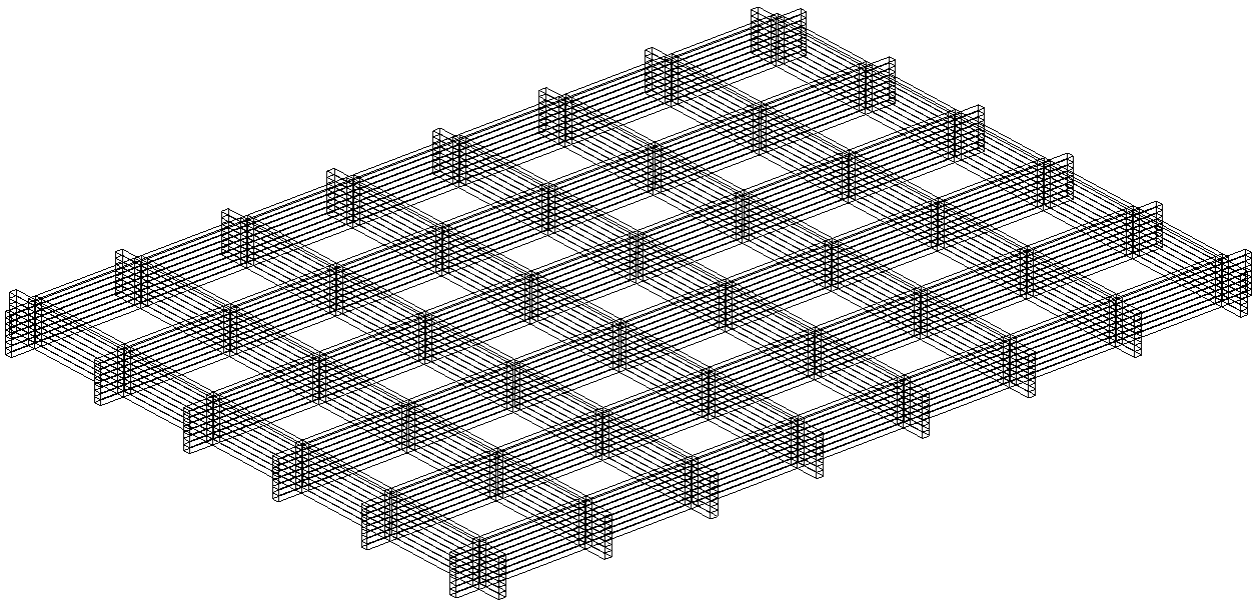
Расчетная схема плиты перекрытия, заданная объемными телами
